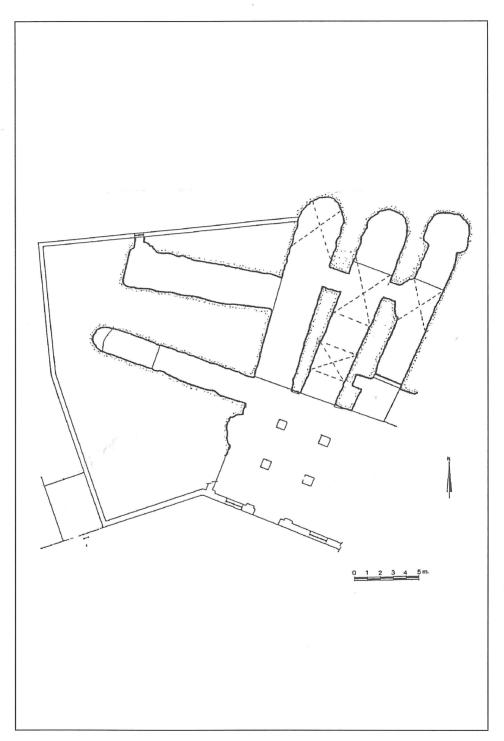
Conjunto rupestre de Archidona (Málaga). Planta (según: Puertas Tricas)
